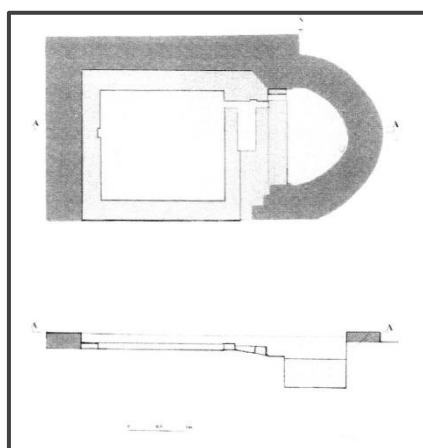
Creta 9. Pianta e sezione del vano battesimale (Mailis 2006, fig. 14, p. 301).
